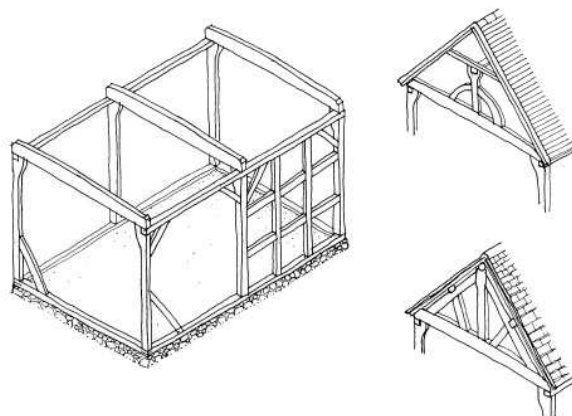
Estrutura em caixa (boxframe structure) [2.17].
